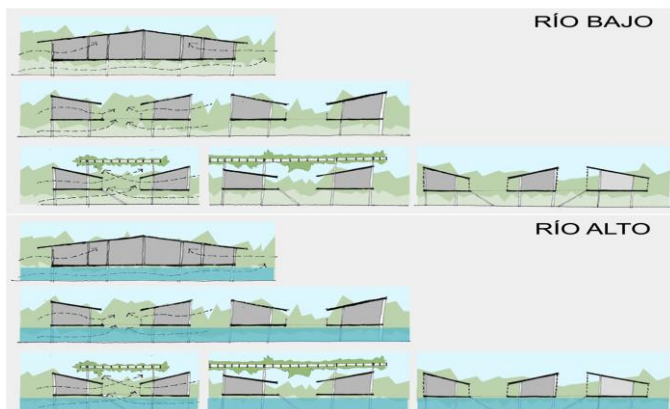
Niveles del río y esquemas de masa edilicia elevada, de planta profunda y planta angosta. Dadas las condiciones climáticas, se requiere una fuerte protección del sol y de la lluvia, y una exposición franca a las brisas. El empleo del suelo bajo los cuerpos edilicios como apropiación transitoria durante los períodos de río bajo, y la necesidad de adecuarse a las condiciones del paisaje natural, favorecen el uso de edificaciones de poca profundidad de planta.
